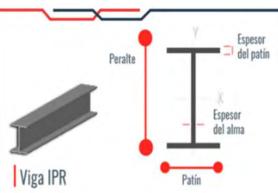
, Detalle de una Viga PTR. Imagen tomada del sitio web Panel y Acanalados Monterrey.
